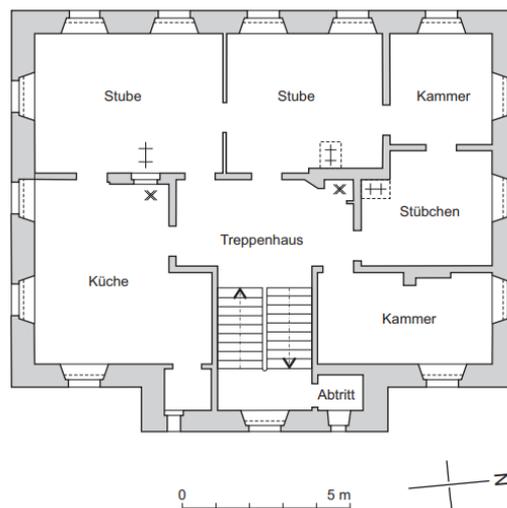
Obergeschoss, Grundriss 1:200.
